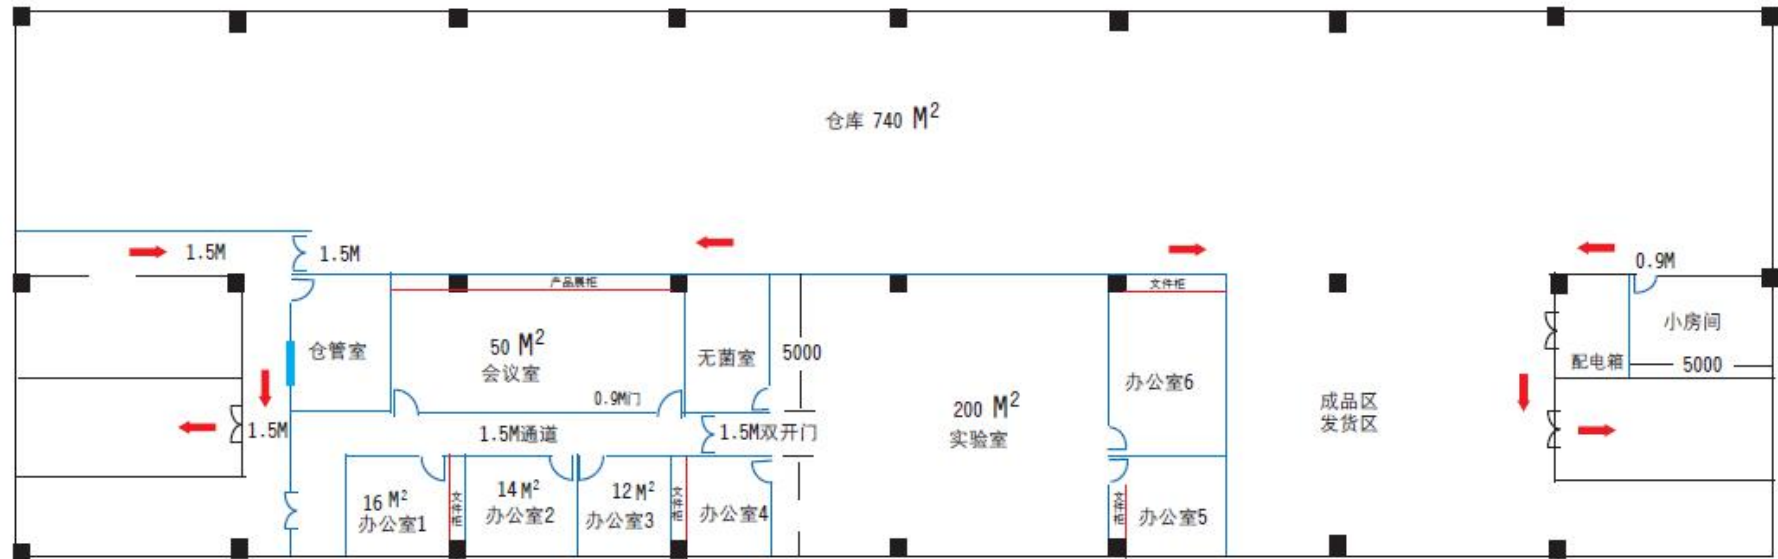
项目2#厂房（3栋4楼）平面布置图
